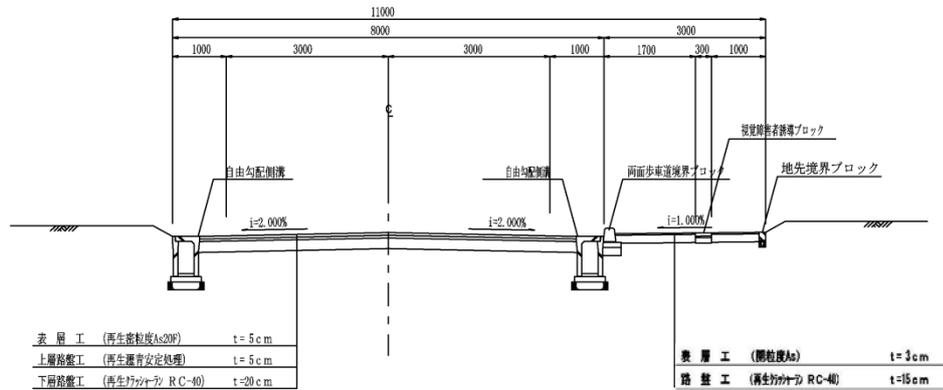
(4) 道路断面図(補助幹線道路:11m 標準断面)
